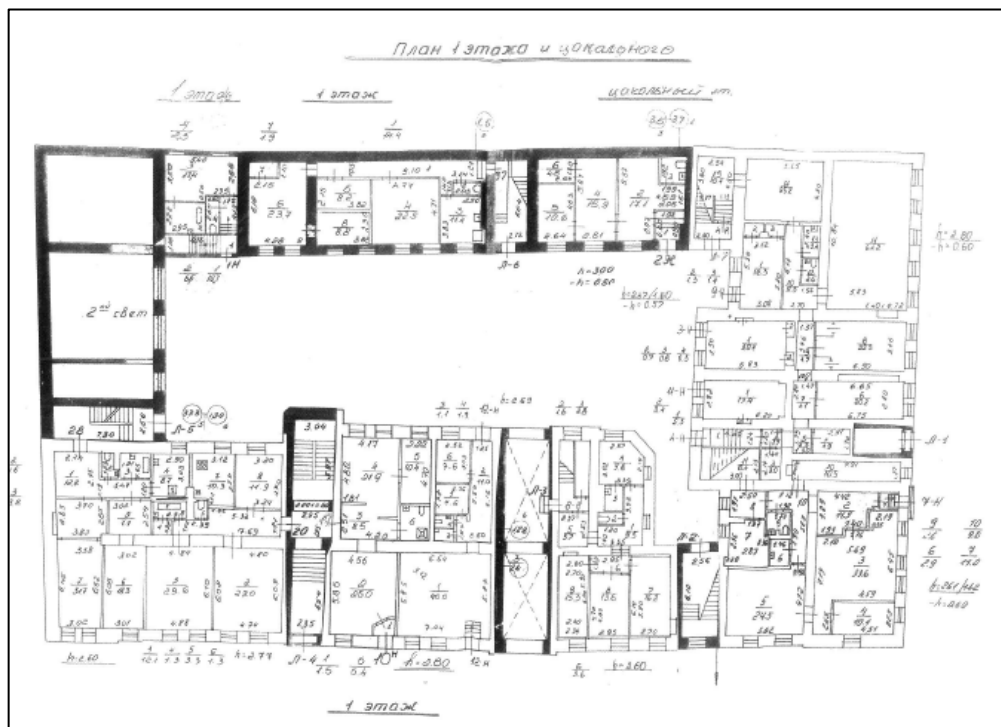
Расположение пом. 1-Н на плане 1 этажа и цокольного этажа здания
